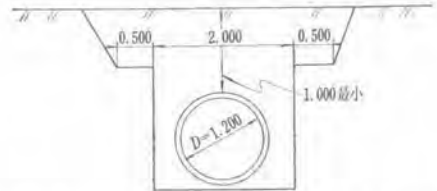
パイプライン標準断面図 (Q=1.5 m³/sec)
